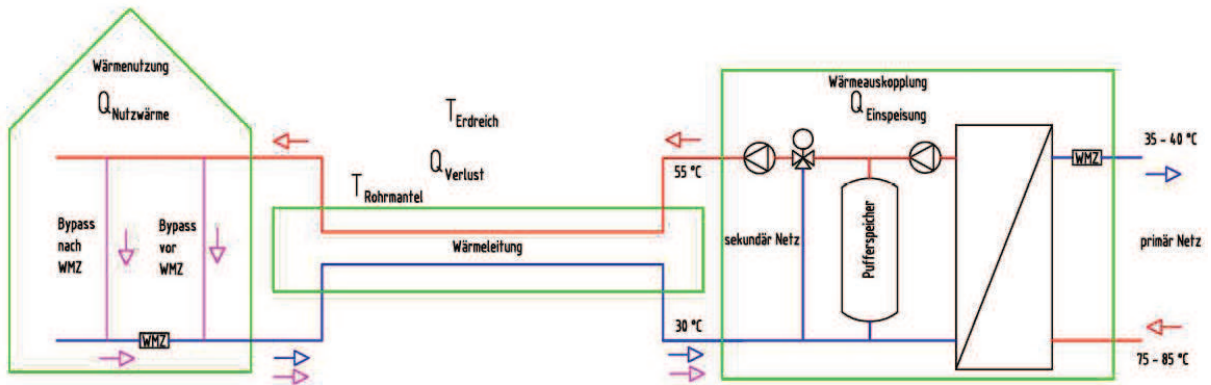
Systemschema mit Lage der Wärmezähler WMZ und Bypass-Leitung
